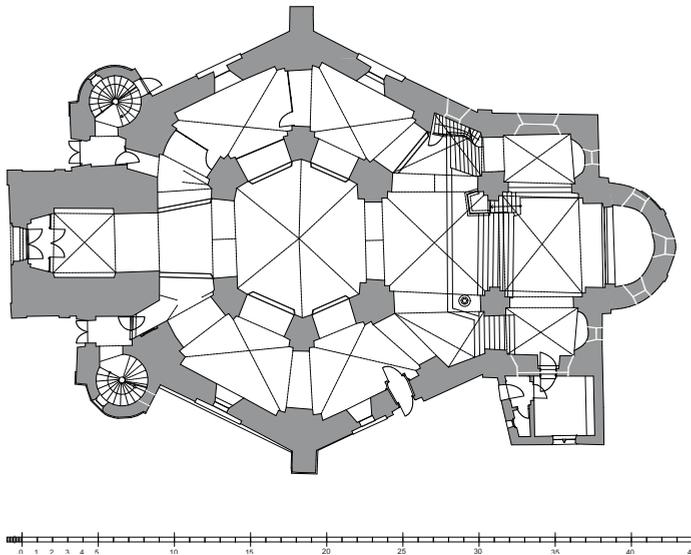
, Grundriss der Siegener Nikolaikirche, formgerechte Bauaufnahme
